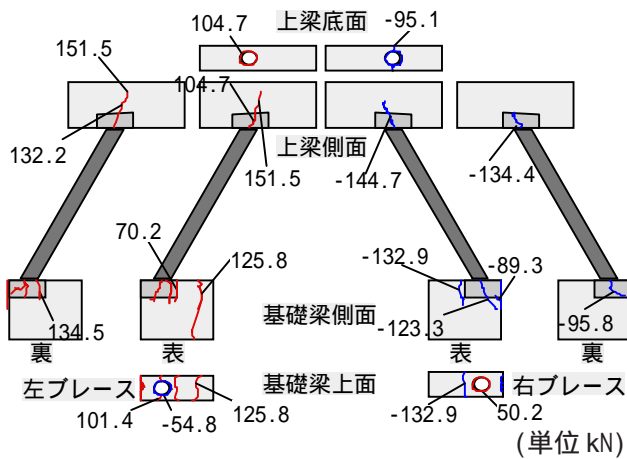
接合部の最大耐力時のひび割れ状況
